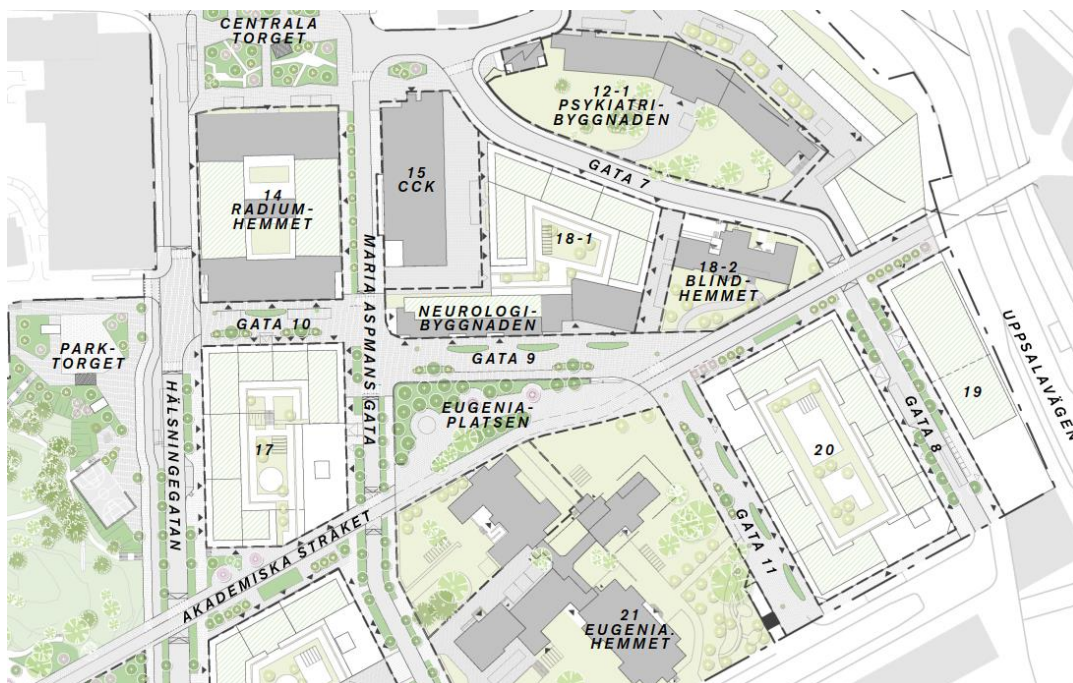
Utdrag ur illustrationsplan av strukturen för detaljplan 1, White arkitekter
